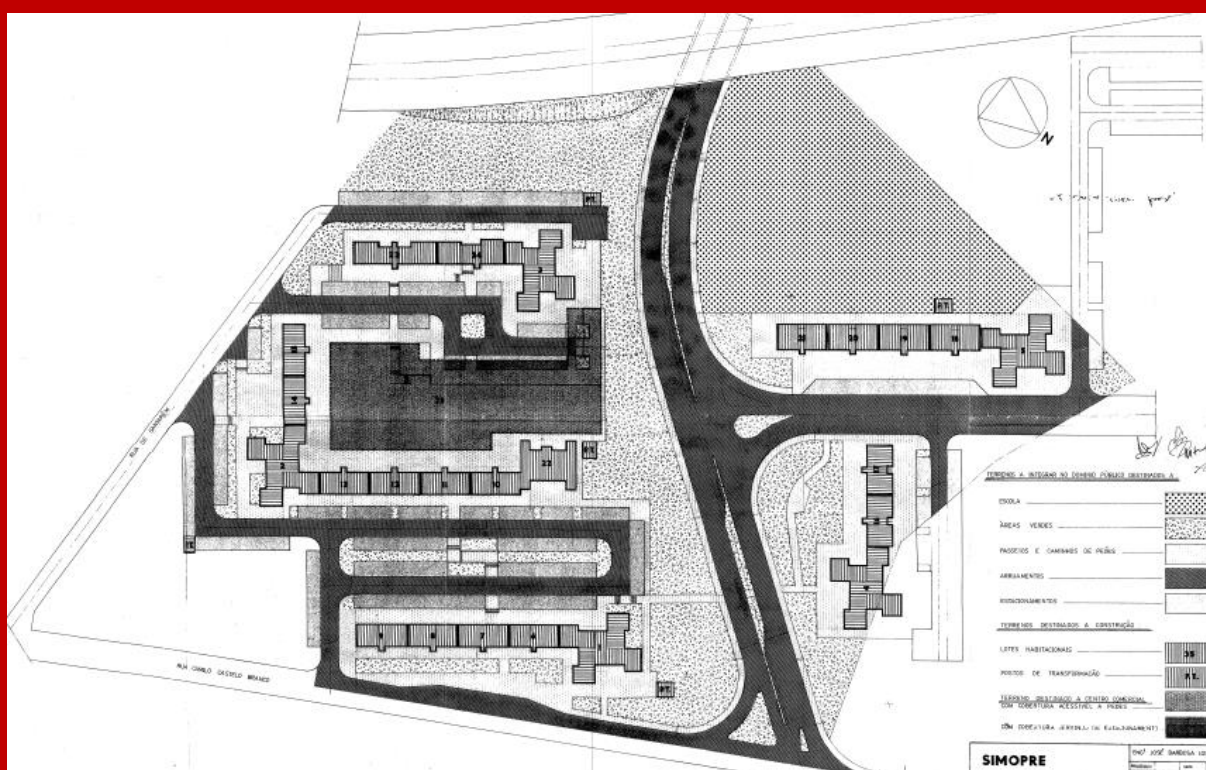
Planta do loteamento da Simopre, na Afurada, de 1981, em VNG.
